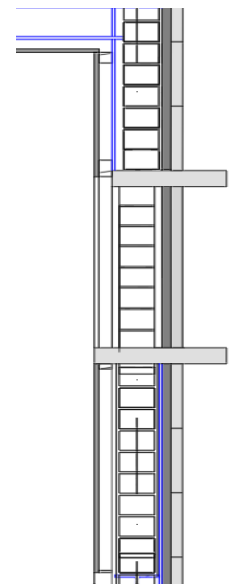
Detalle envolvente fachada tercera planta Autor: Estudio VVV
